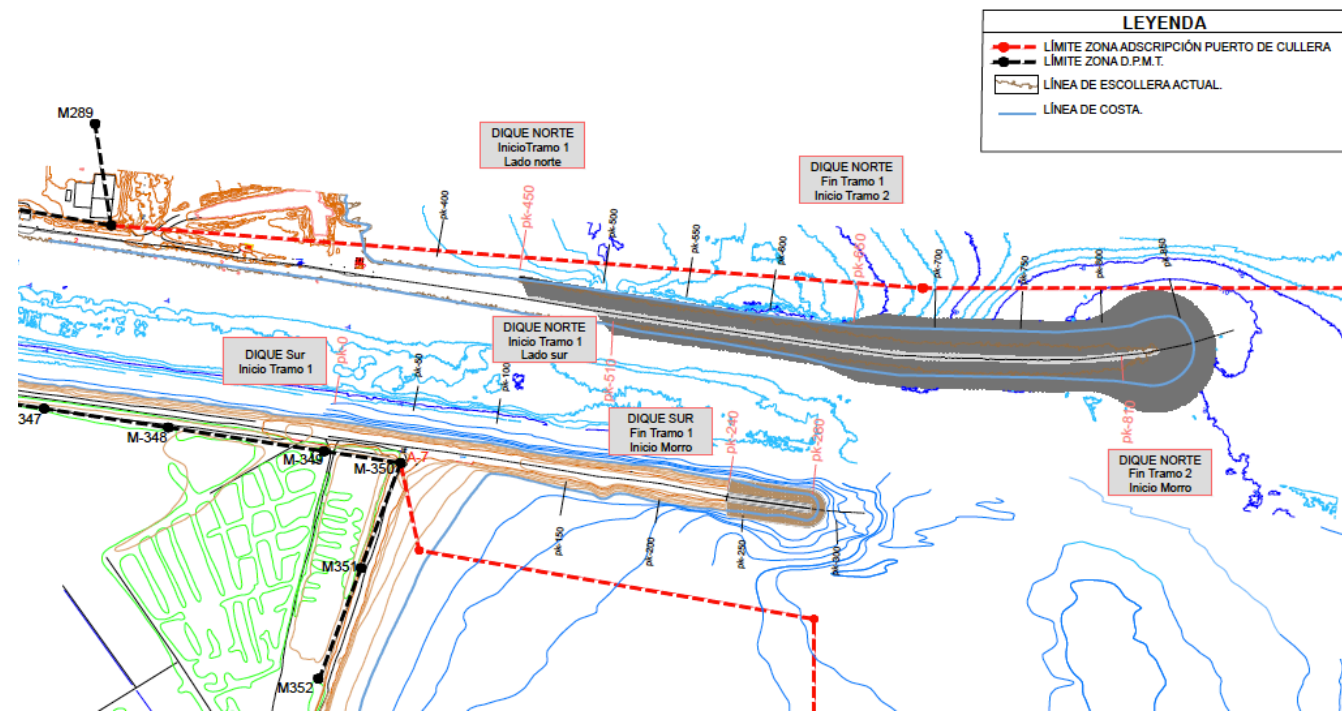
Figura VI.a.- Plano en planta de las solución adoptada (Elaboración propia, 2018).
